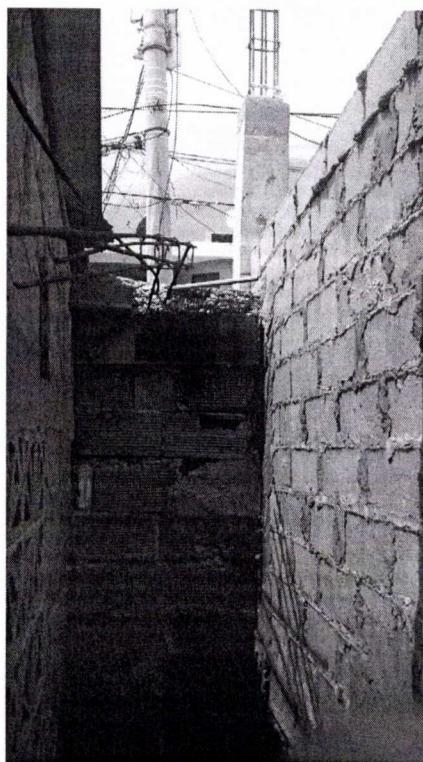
Vista Levantamiento Muro Lateral Derecho 3.00 Mts alto
